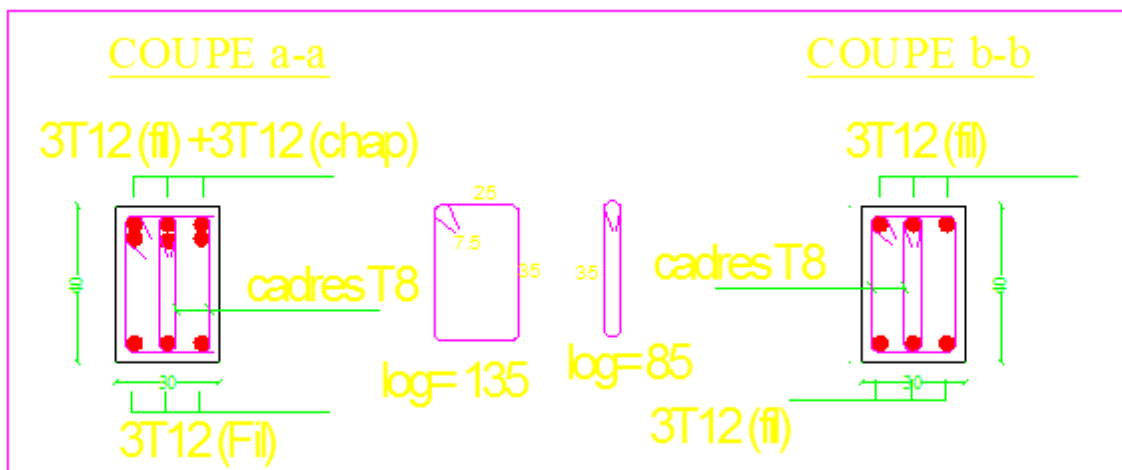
Ferraillage poutres principales adhéres aux voiles
